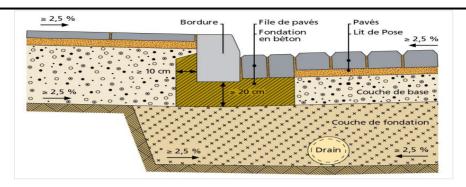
Coupe transversale d'une chaussée en pavés avec trottoirs
